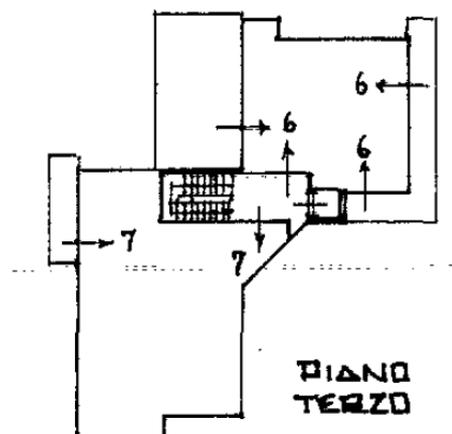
Estratto dell’elaborato planimetrico – piano terzo
